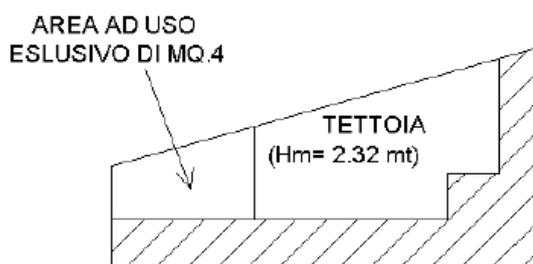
Estratto planimetria catastale, relativa alla tettoia sub. 27
